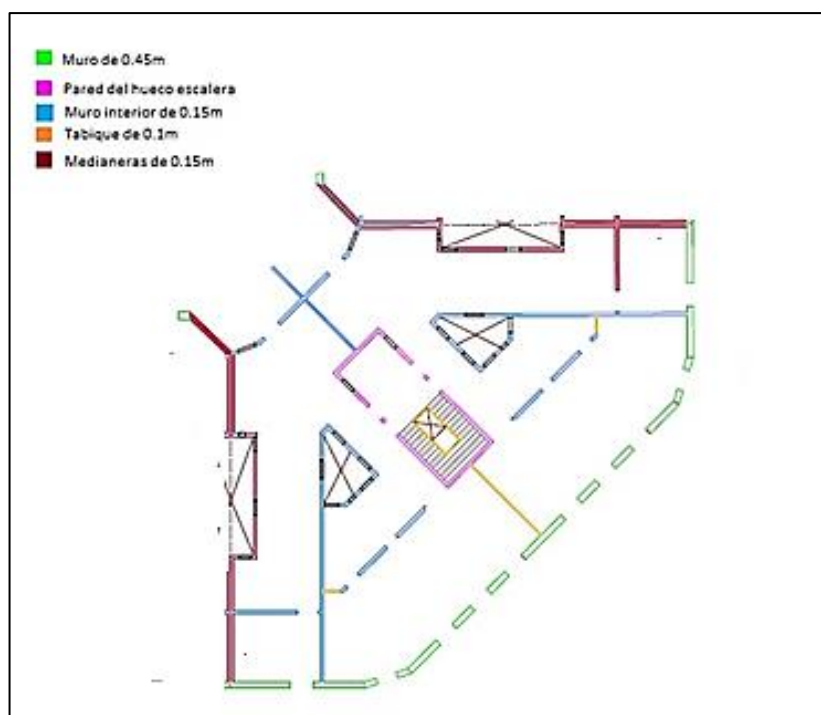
Planta tipo del edificio (Fuente: Propia)
